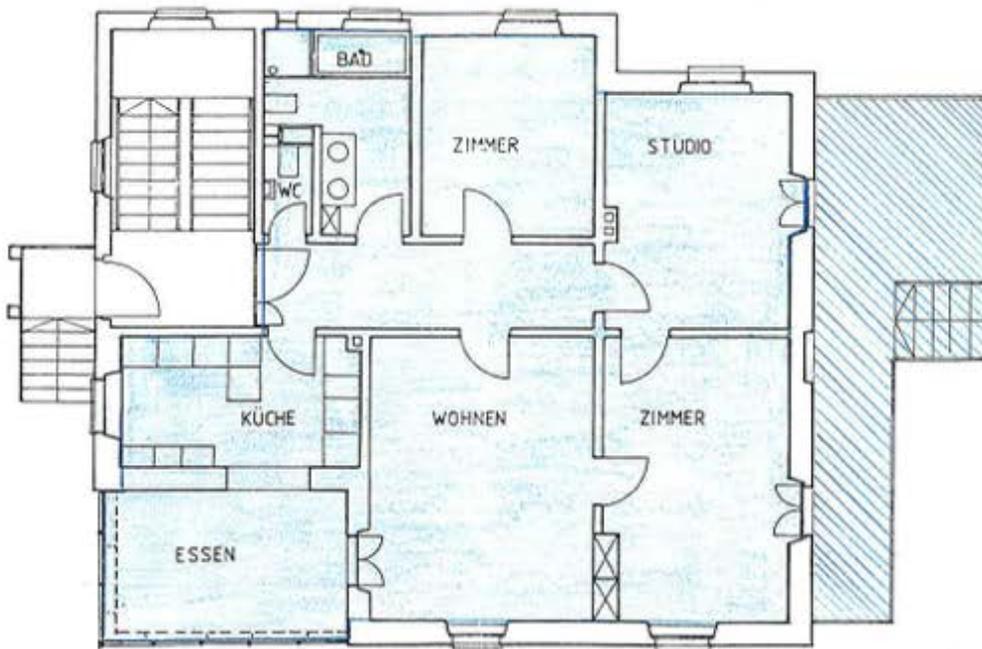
Grundriss Erdgeschoss Lettenstrasse 3, 8408 Winterthur
